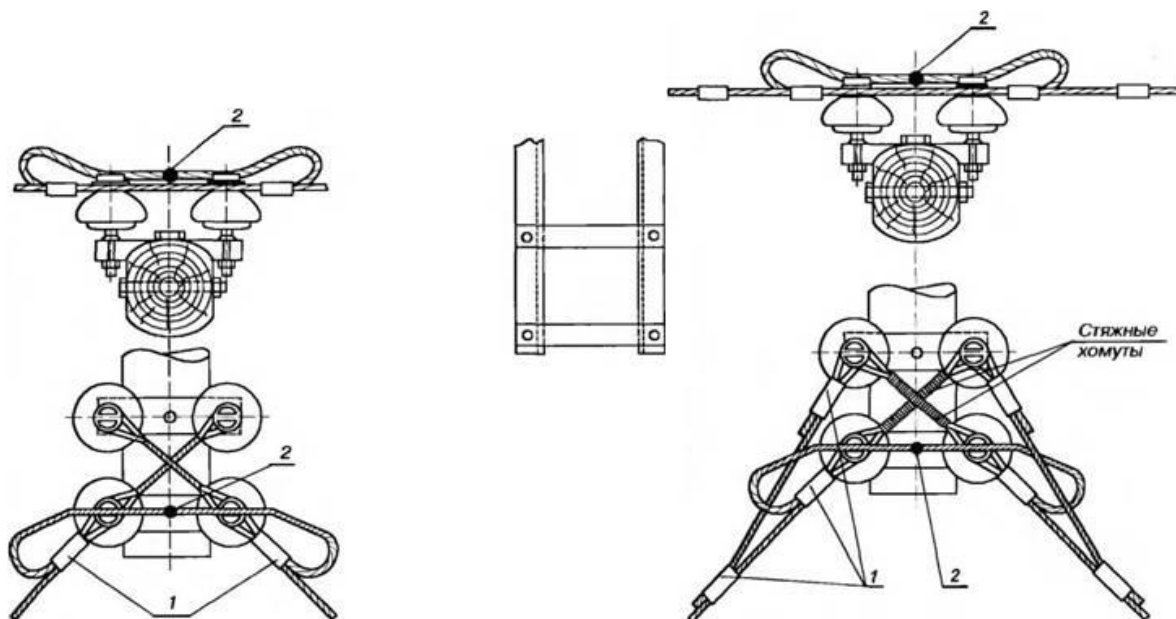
Двойное усиленное угловое крепление провода на штыревых изоляторах угловой опоры:
